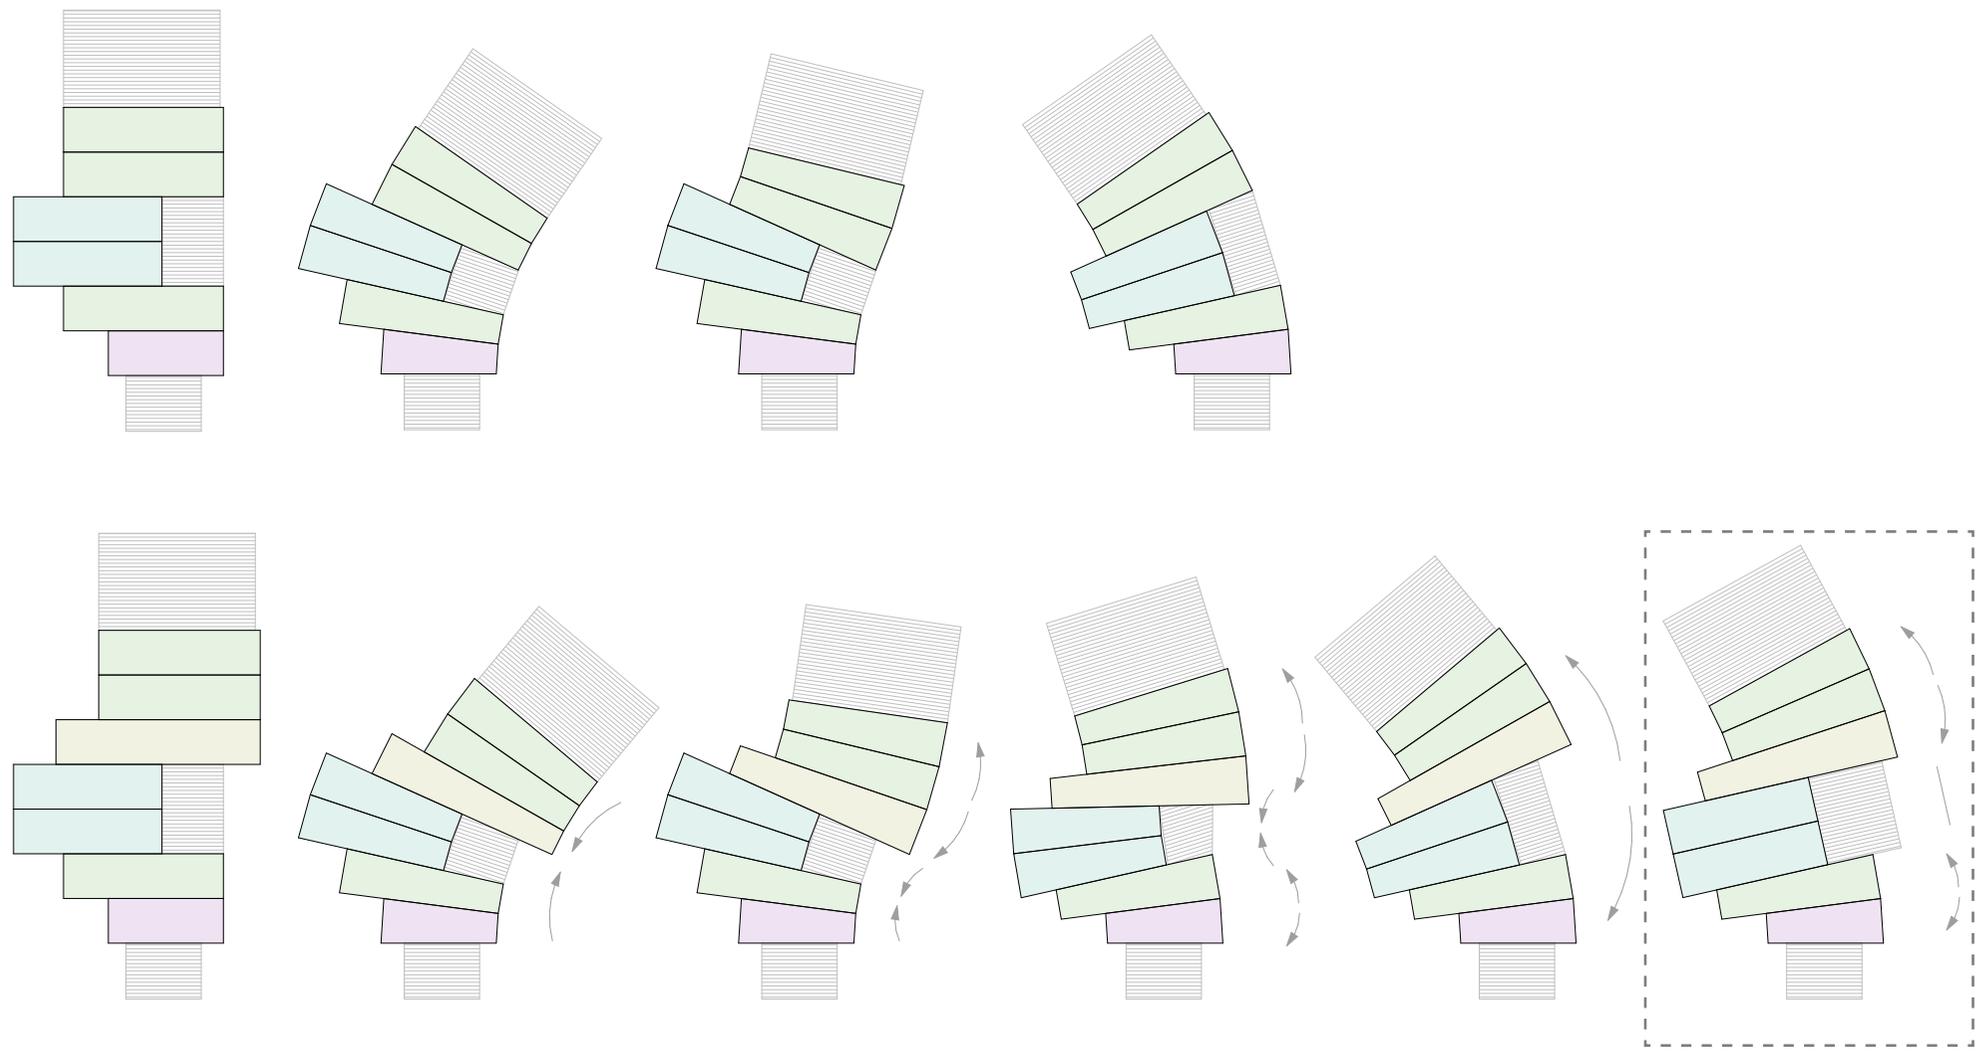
Formveränderung- Krümmung des Baumhauses
